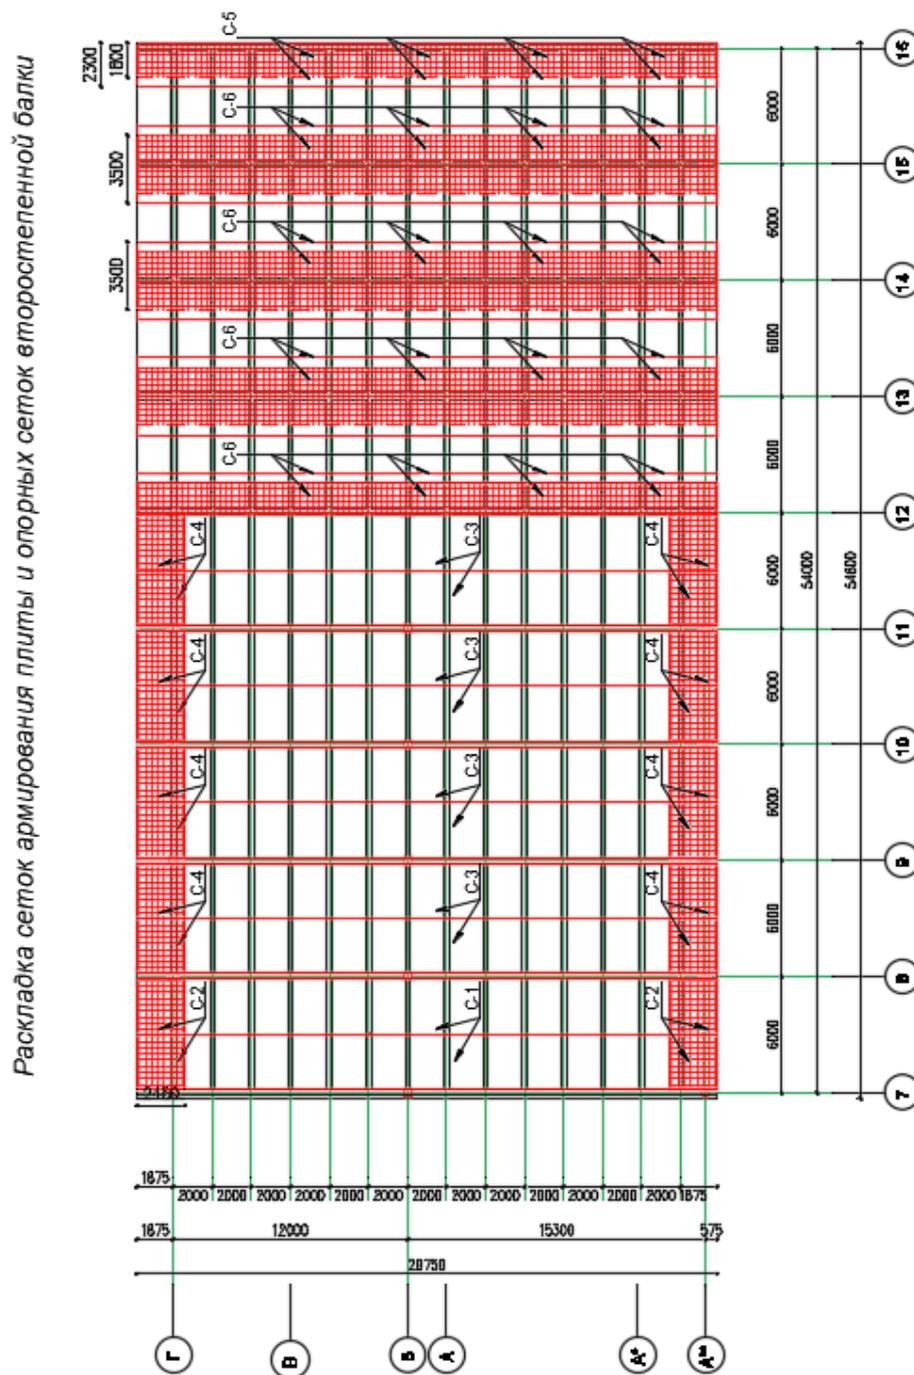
Раскладка армирования плиты и опорных сеток второстепенной балки (выделены штриховкой двойные сетки)
